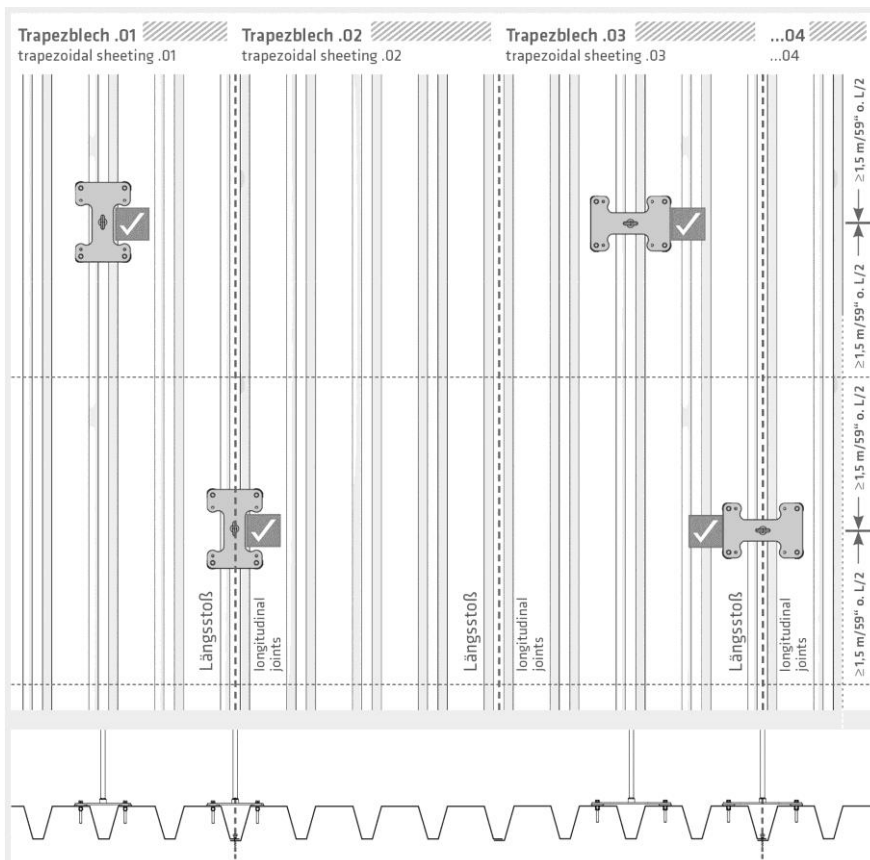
Montagevorgaben auf Trapezprofil bei Absturzrichtung in Trapezprofilspannrichtung
